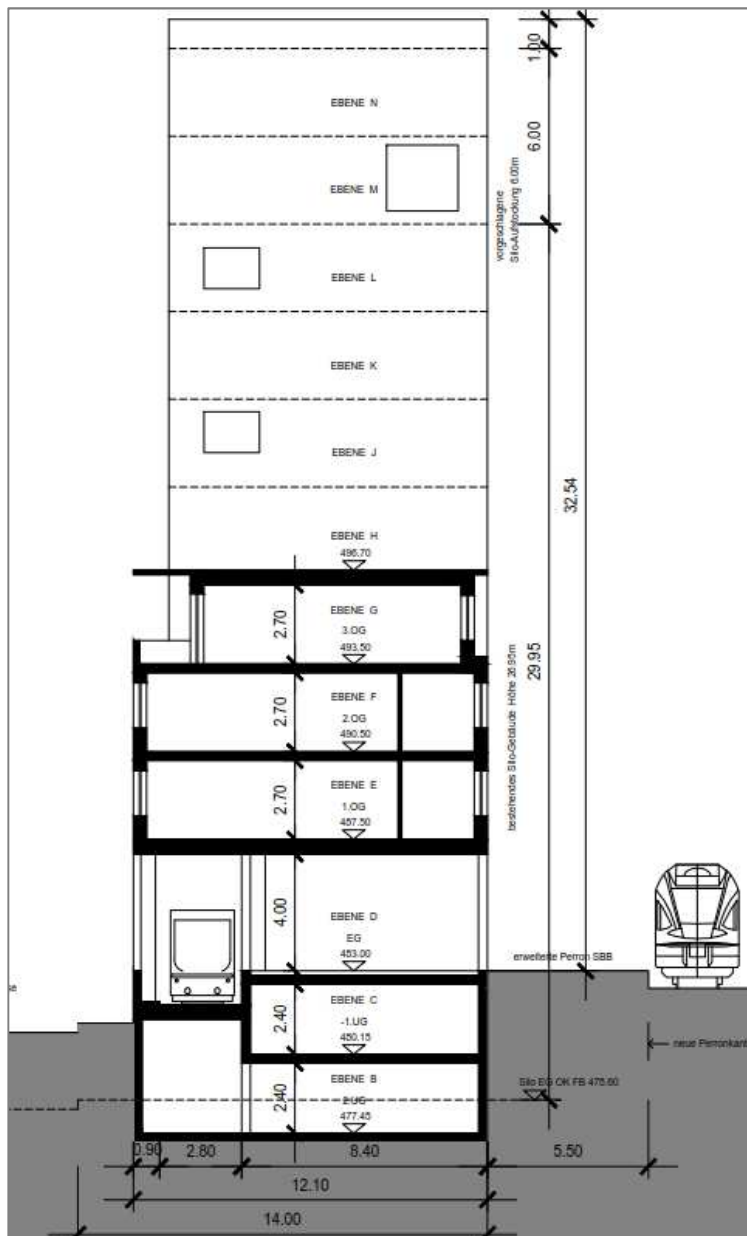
Schnitt durch Gebäude (Plan des Architekten)
